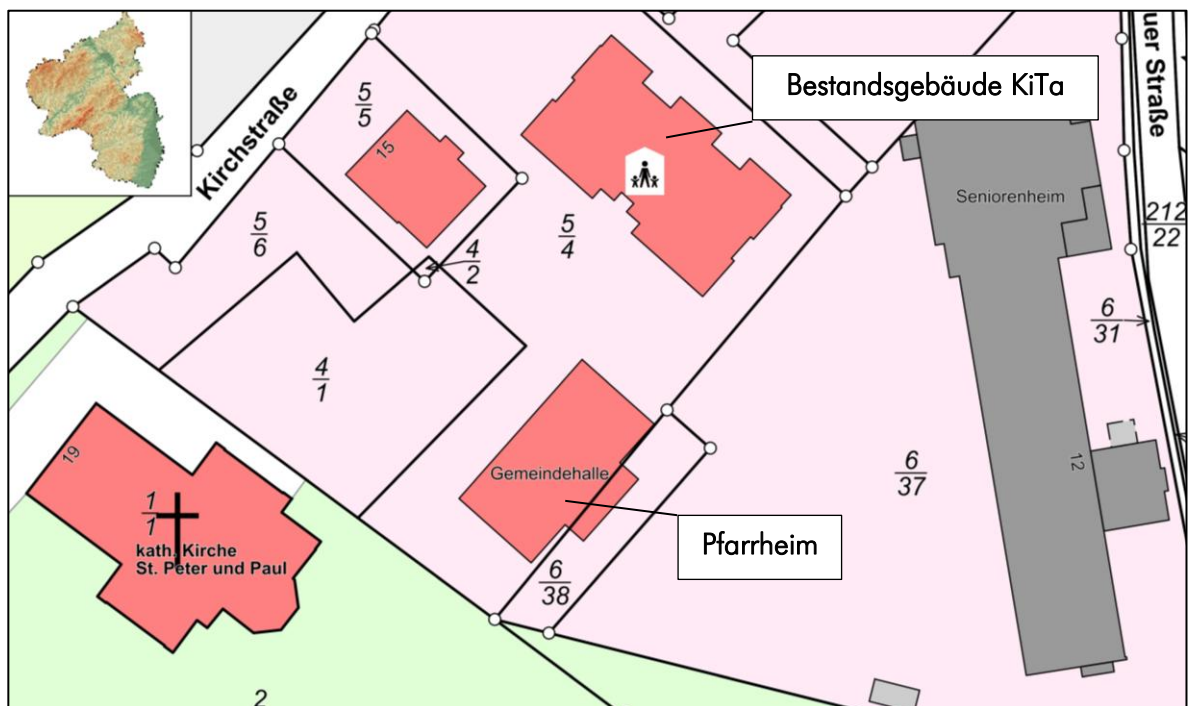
Lageplan mit Markierung der betrachteten Bestandsimmobilien
